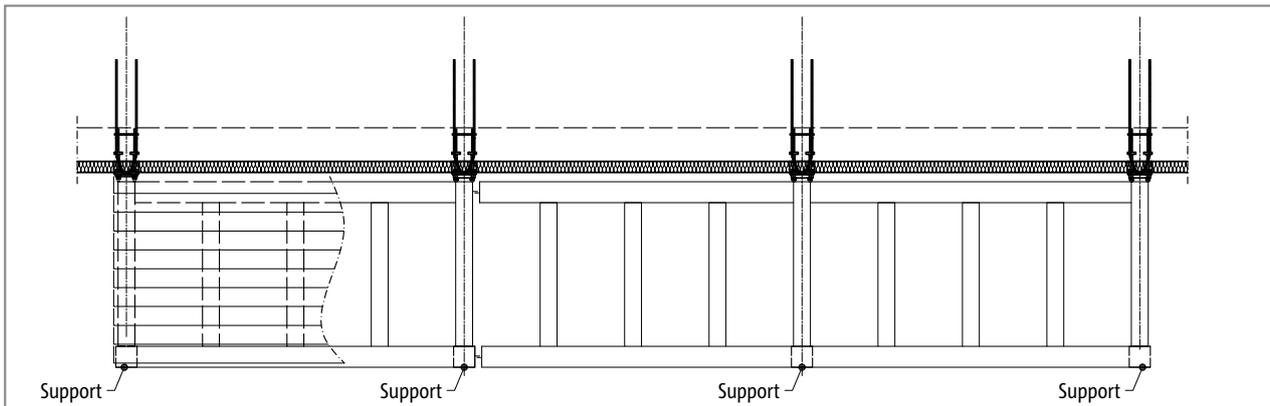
Schöck Isokorb® T type SQ : Balcon avec appuis
